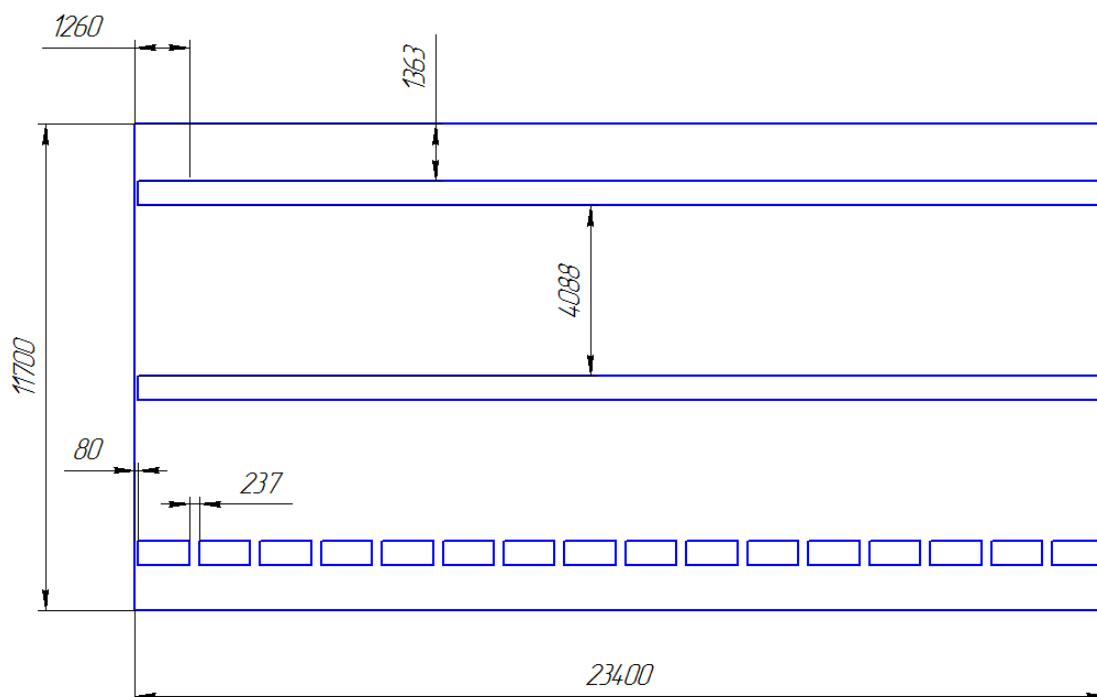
План помещения и размещения светильников с люминесцентными лампами
